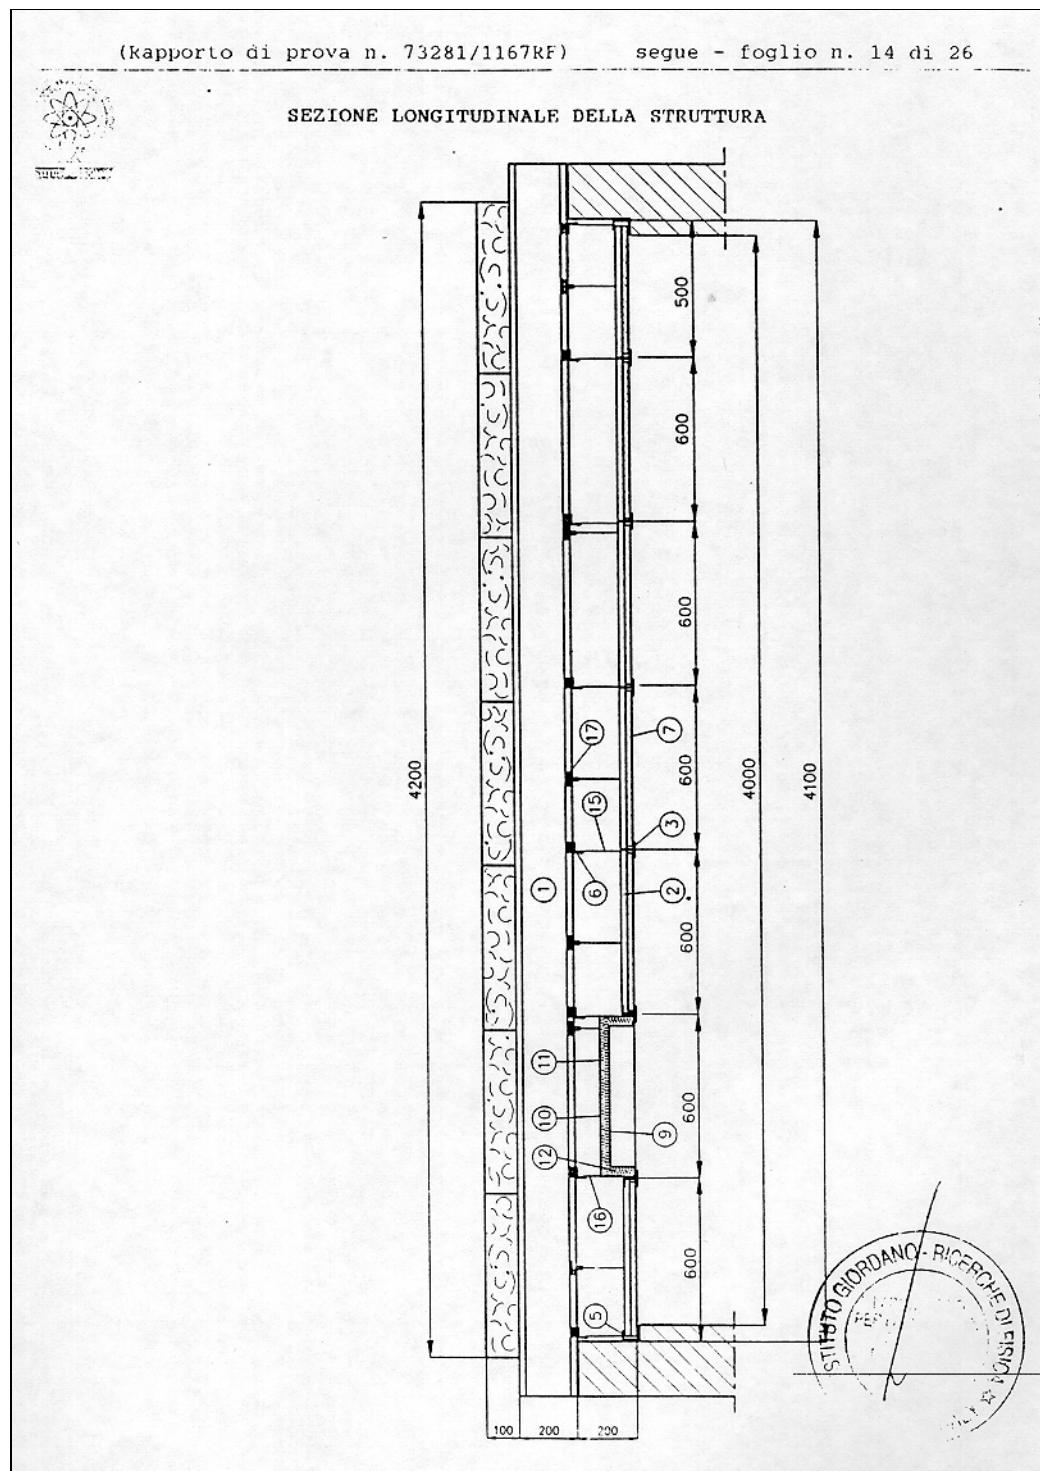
SEZIONE LONGITUDINALE DELLA STRUTTURA DEL CONTROSOFFITTO
